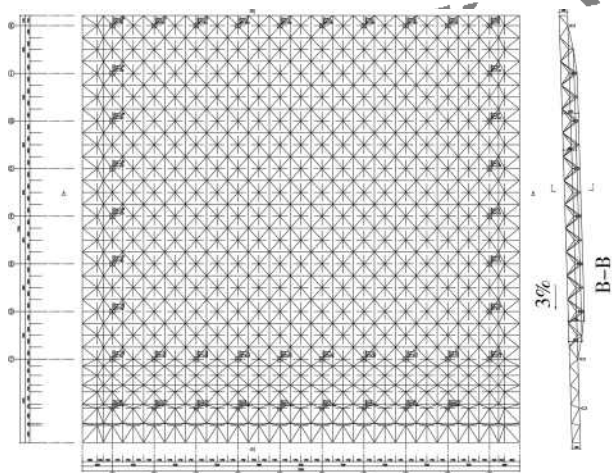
(a) 某篮球馆网架结构平面布置图
